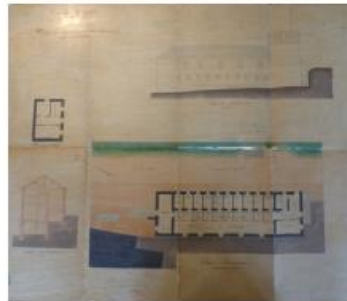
Plan de l'établissement du Bouridé, 1865.
